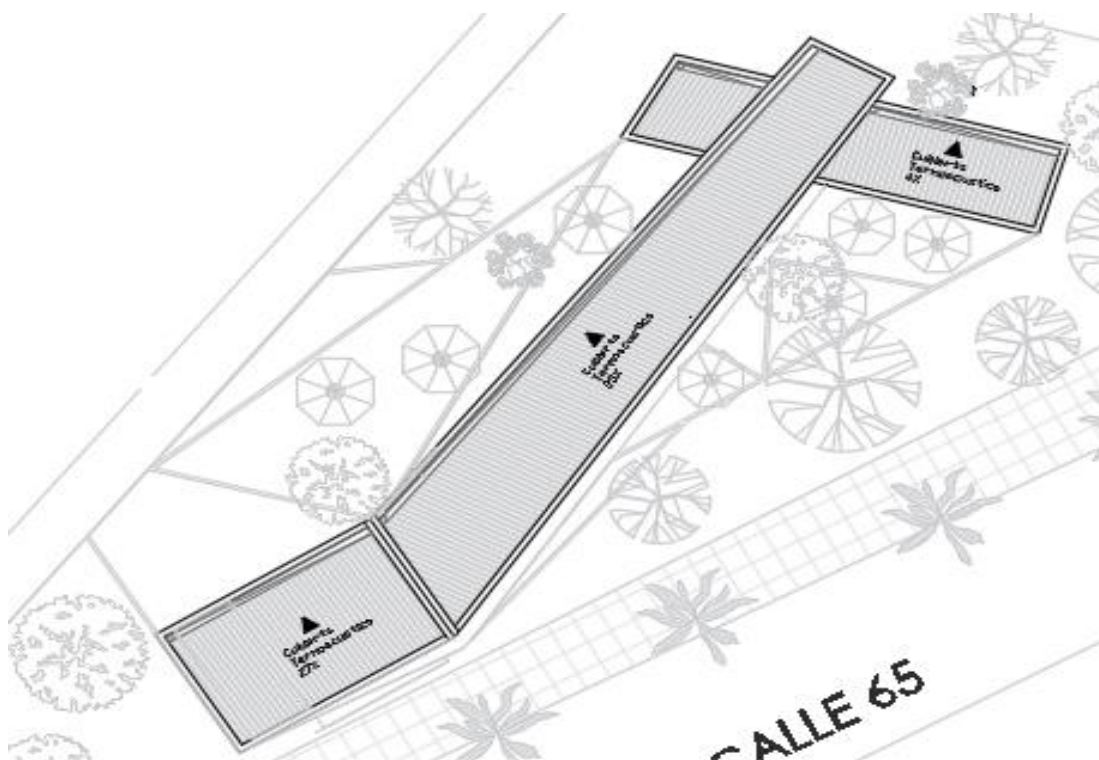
Planta Cubiertas. (Fuente: Elaboración propia)
